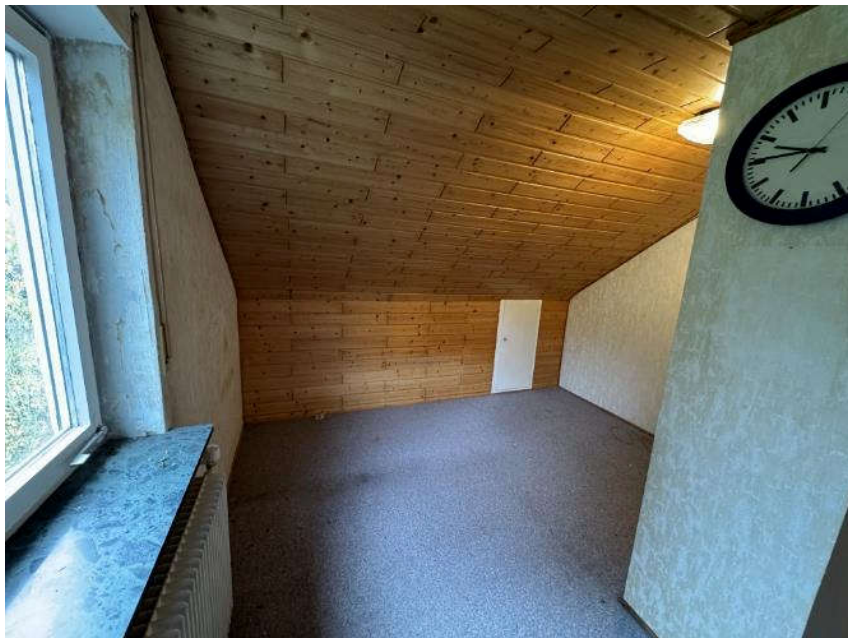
Zimmer im Dachgeschoss mit Fenster nach Nordosten
